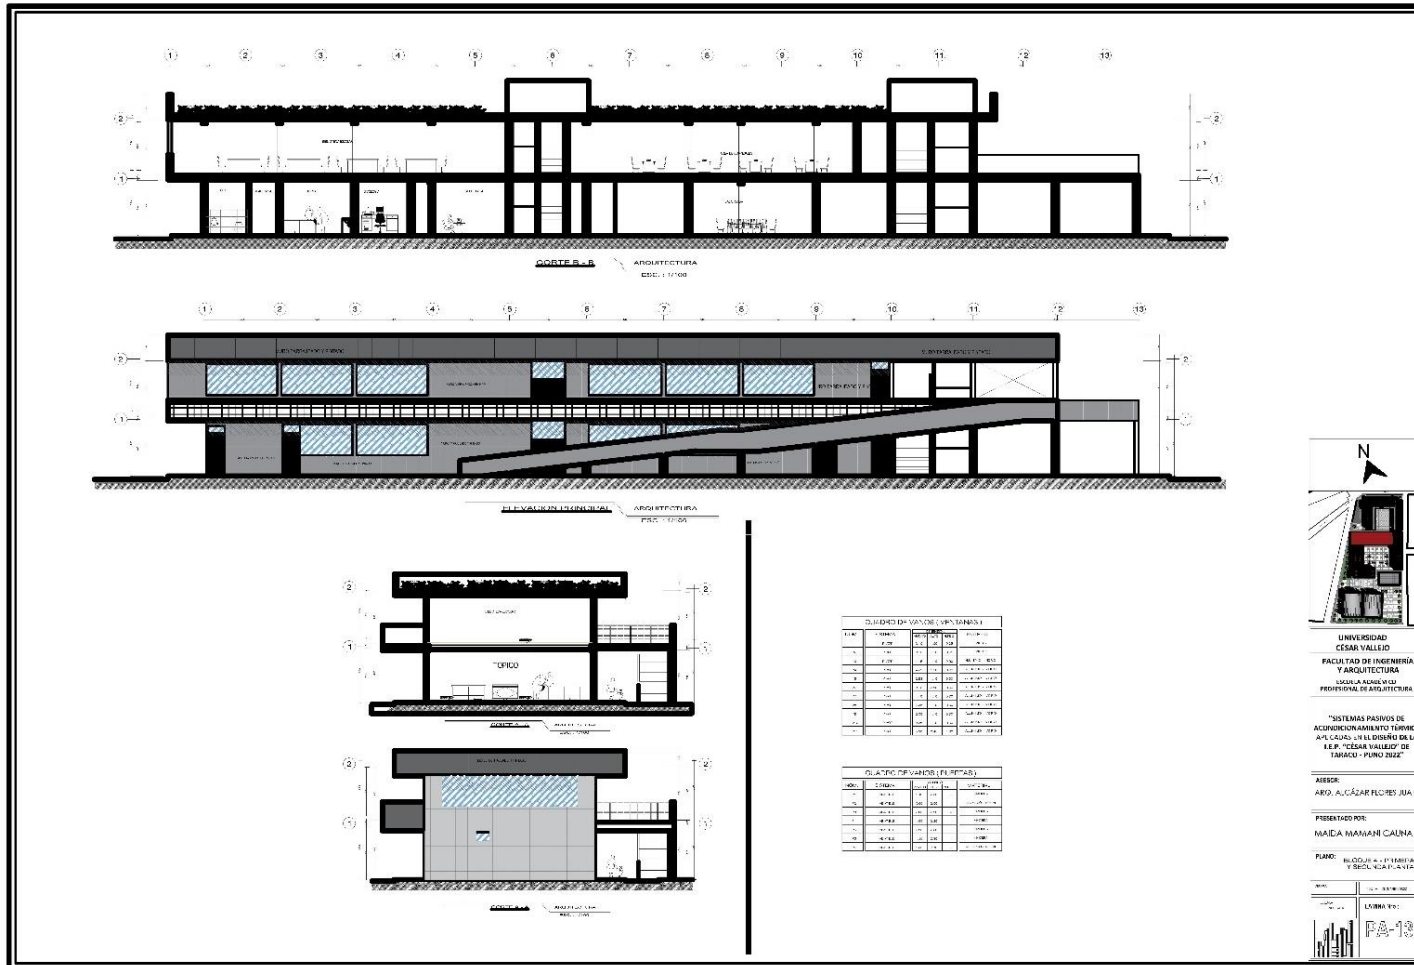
Arquitectura Cortes y Elevaciones primer y segundo nivel – bloque 3
